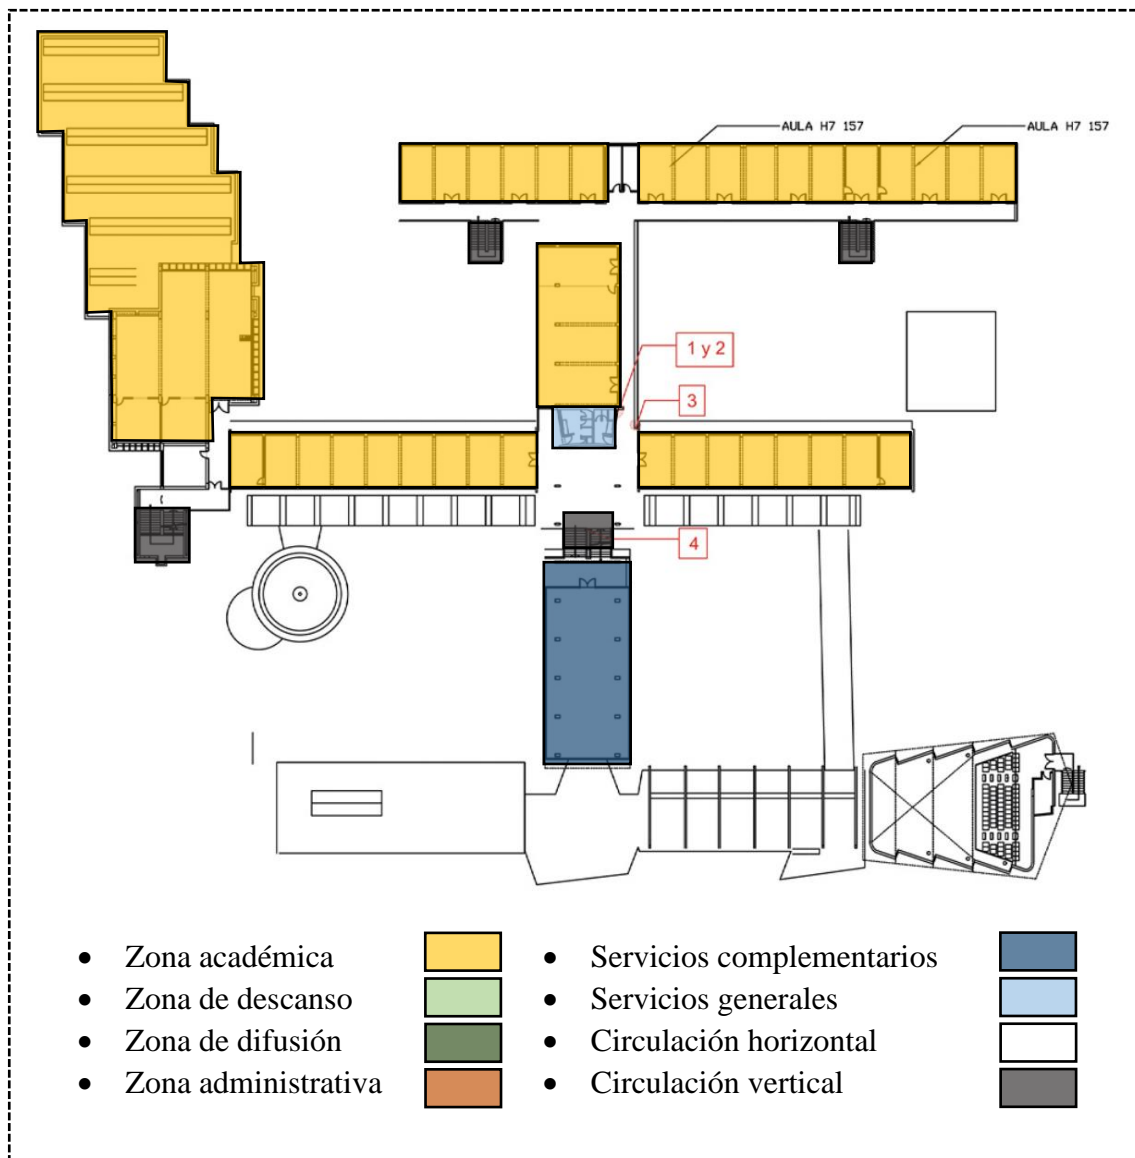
Planta alta del edificio de la FAUA-UNI. (Fuente: Lorena Olazábal Furuya)
